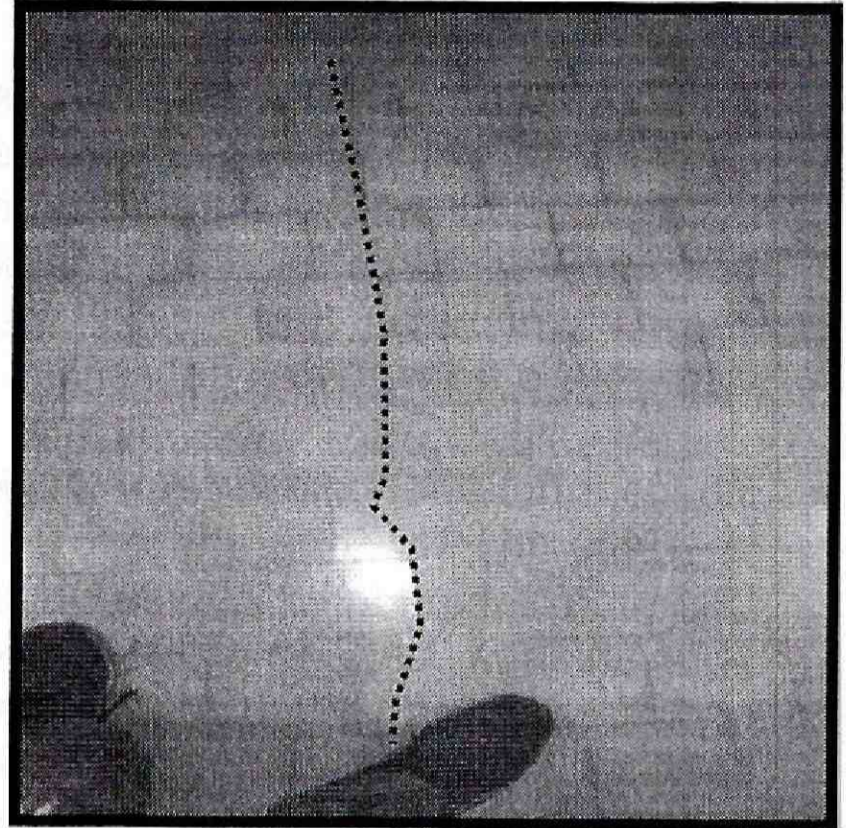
Junta de separación entre el sendero peatonal del costado norte, y las entradas a los apartamentos de las Torres.
